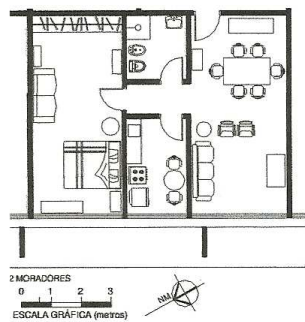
Planta baixa de apartamento do bloco F (Fonte: GALVÃO e ORNSTEIN, 2008, p.8)
